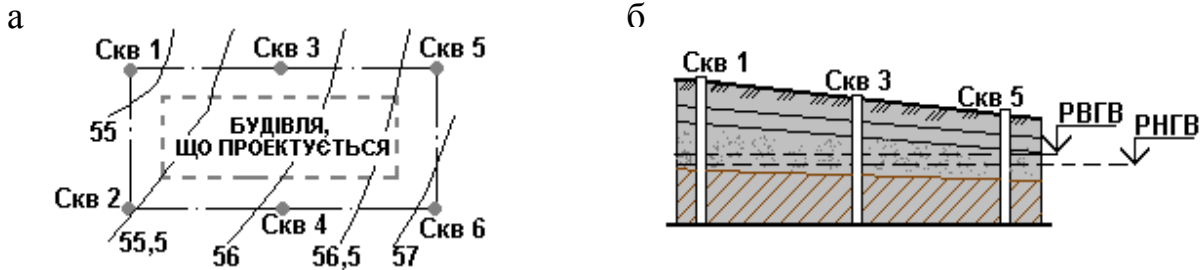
Приклад геологічного розрізу ділянки будівництва будівлі: а – план розташування свердловин; б – геологічний профіль ґрунтового масиву; РВГВ – рівень верхніх ґрунтових вод; РНГВ – рівень нижніх ґрунтових вод
